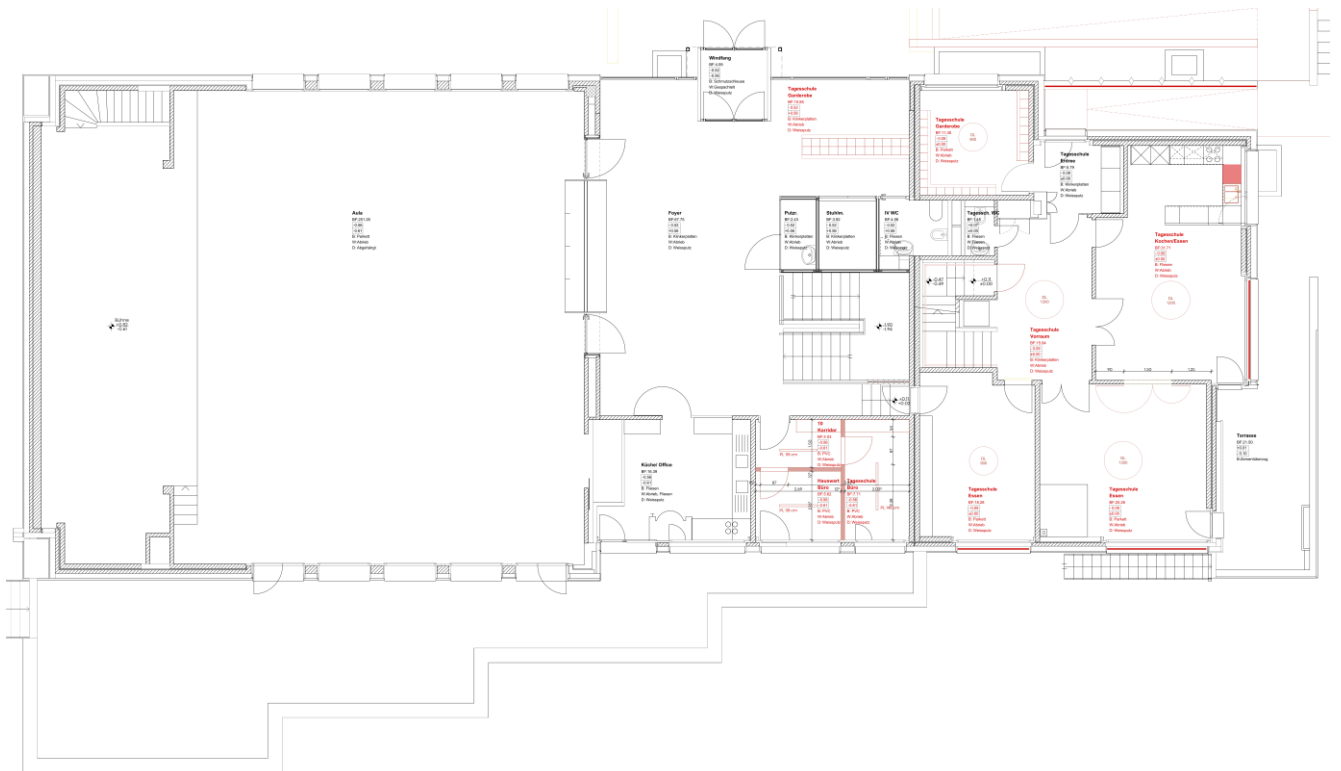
Grundriss Erdgeschoss, Gebäude 3
